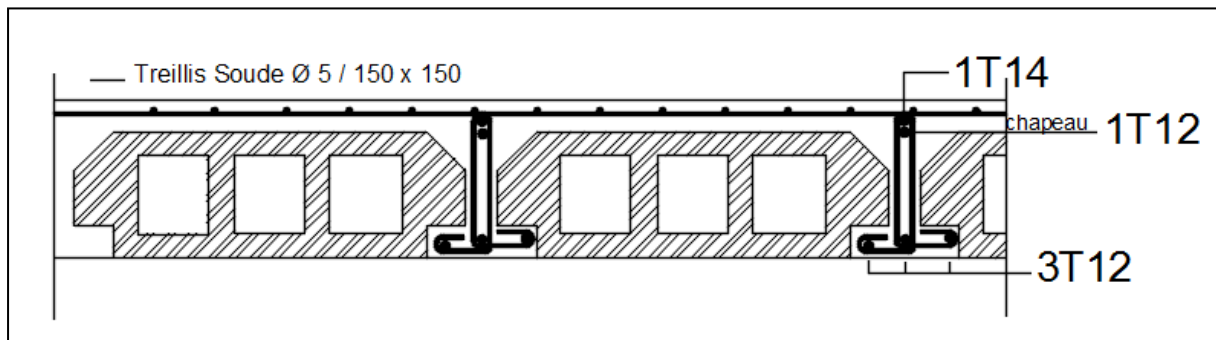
Schéma de ferrailage de la dalle de compression.
